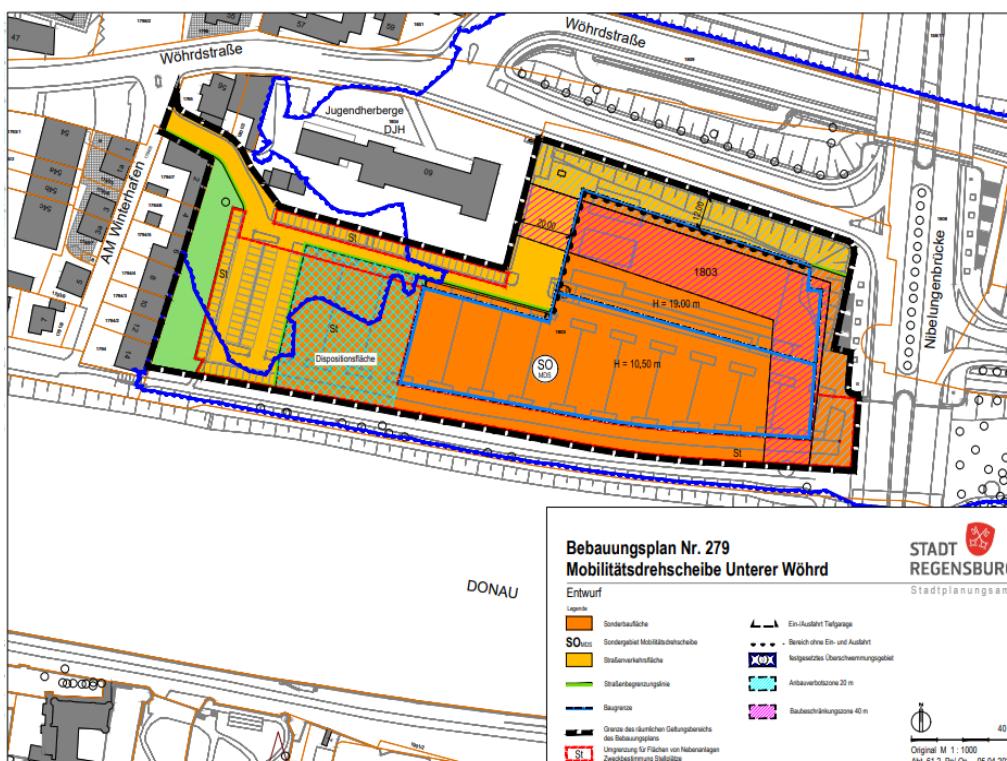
Entwurf Bebauungsplan Nr. 279, altes Eisstadion, Stadt Regensburg
